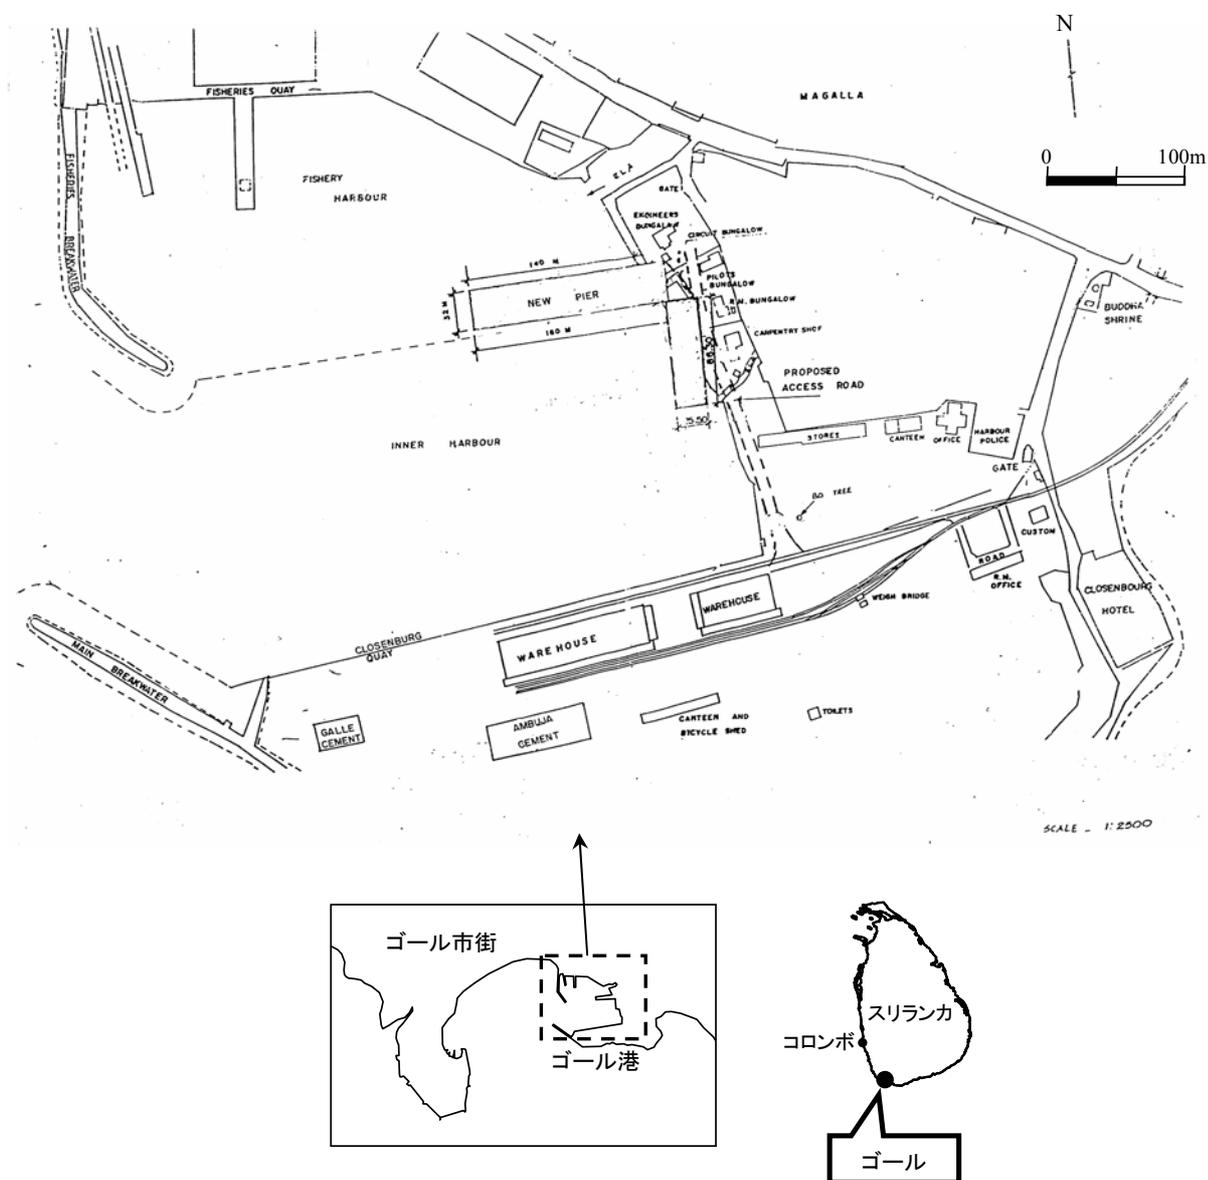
ゴール港の平面図及び港湾施設等の配置状況
